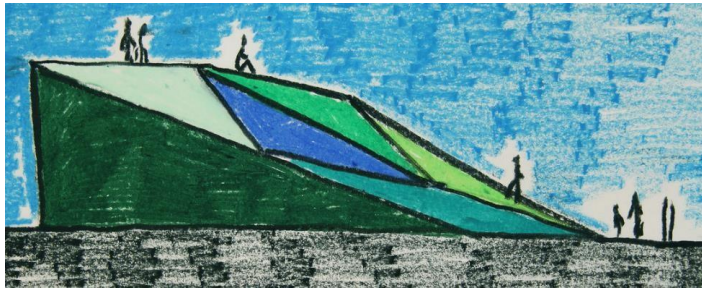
CENTRO DE LAS MONTAÑAS KRKONOŠE PARA LA EDUCACIÓN AMBIENTAL VISTA 2
